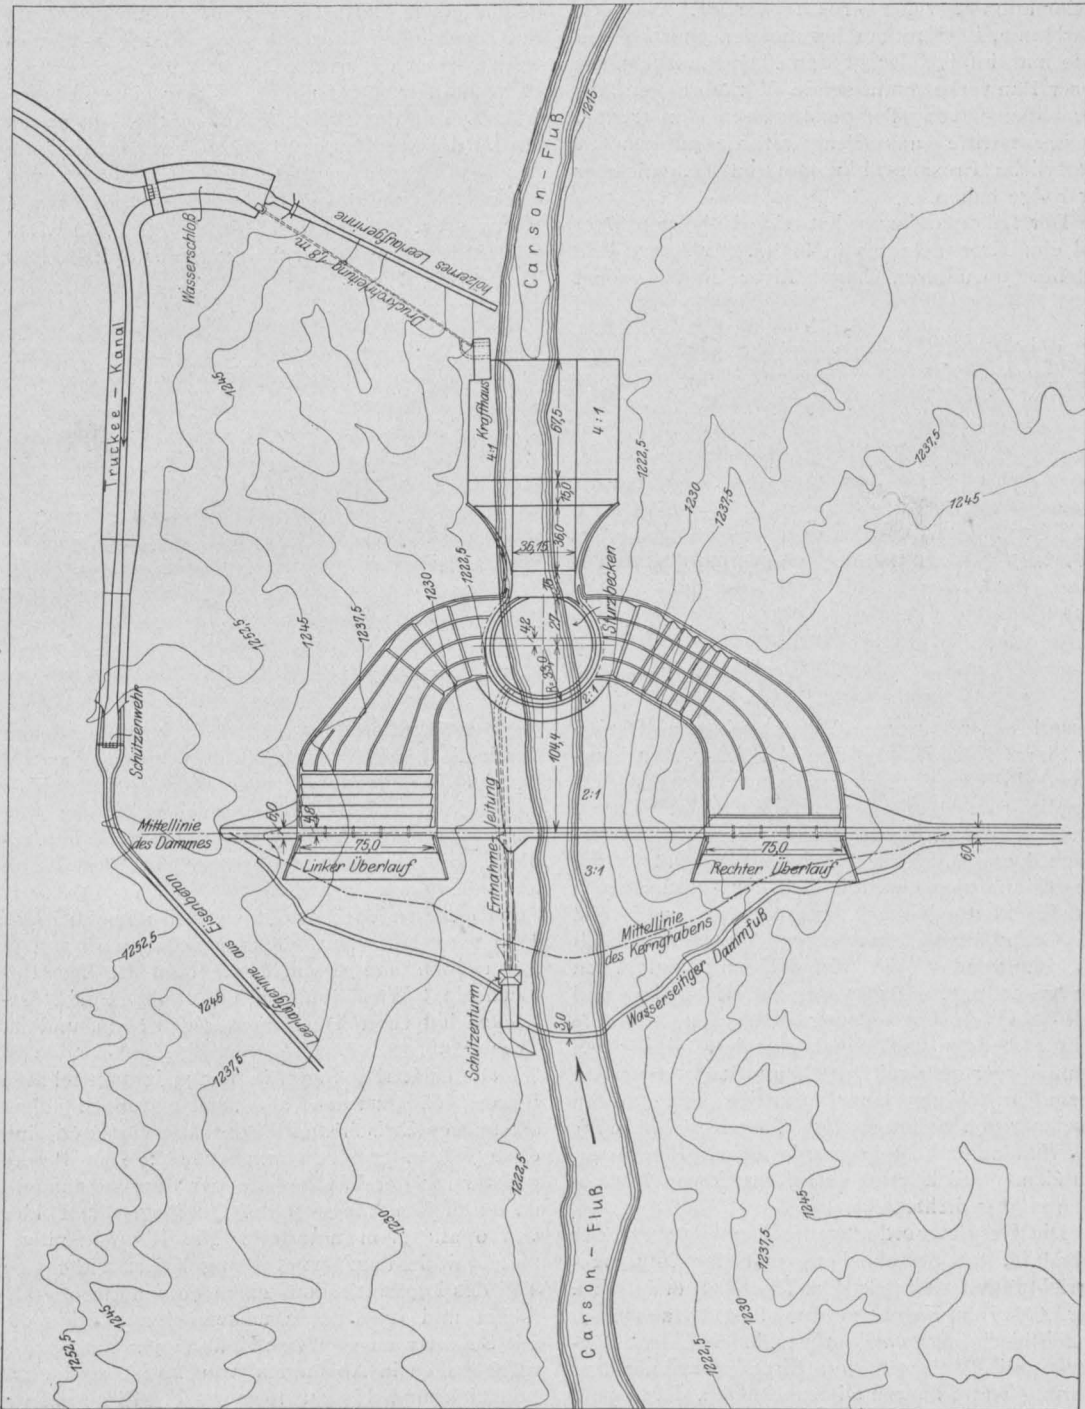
Lageplan des Lahontan-Dammes, Nevada.
